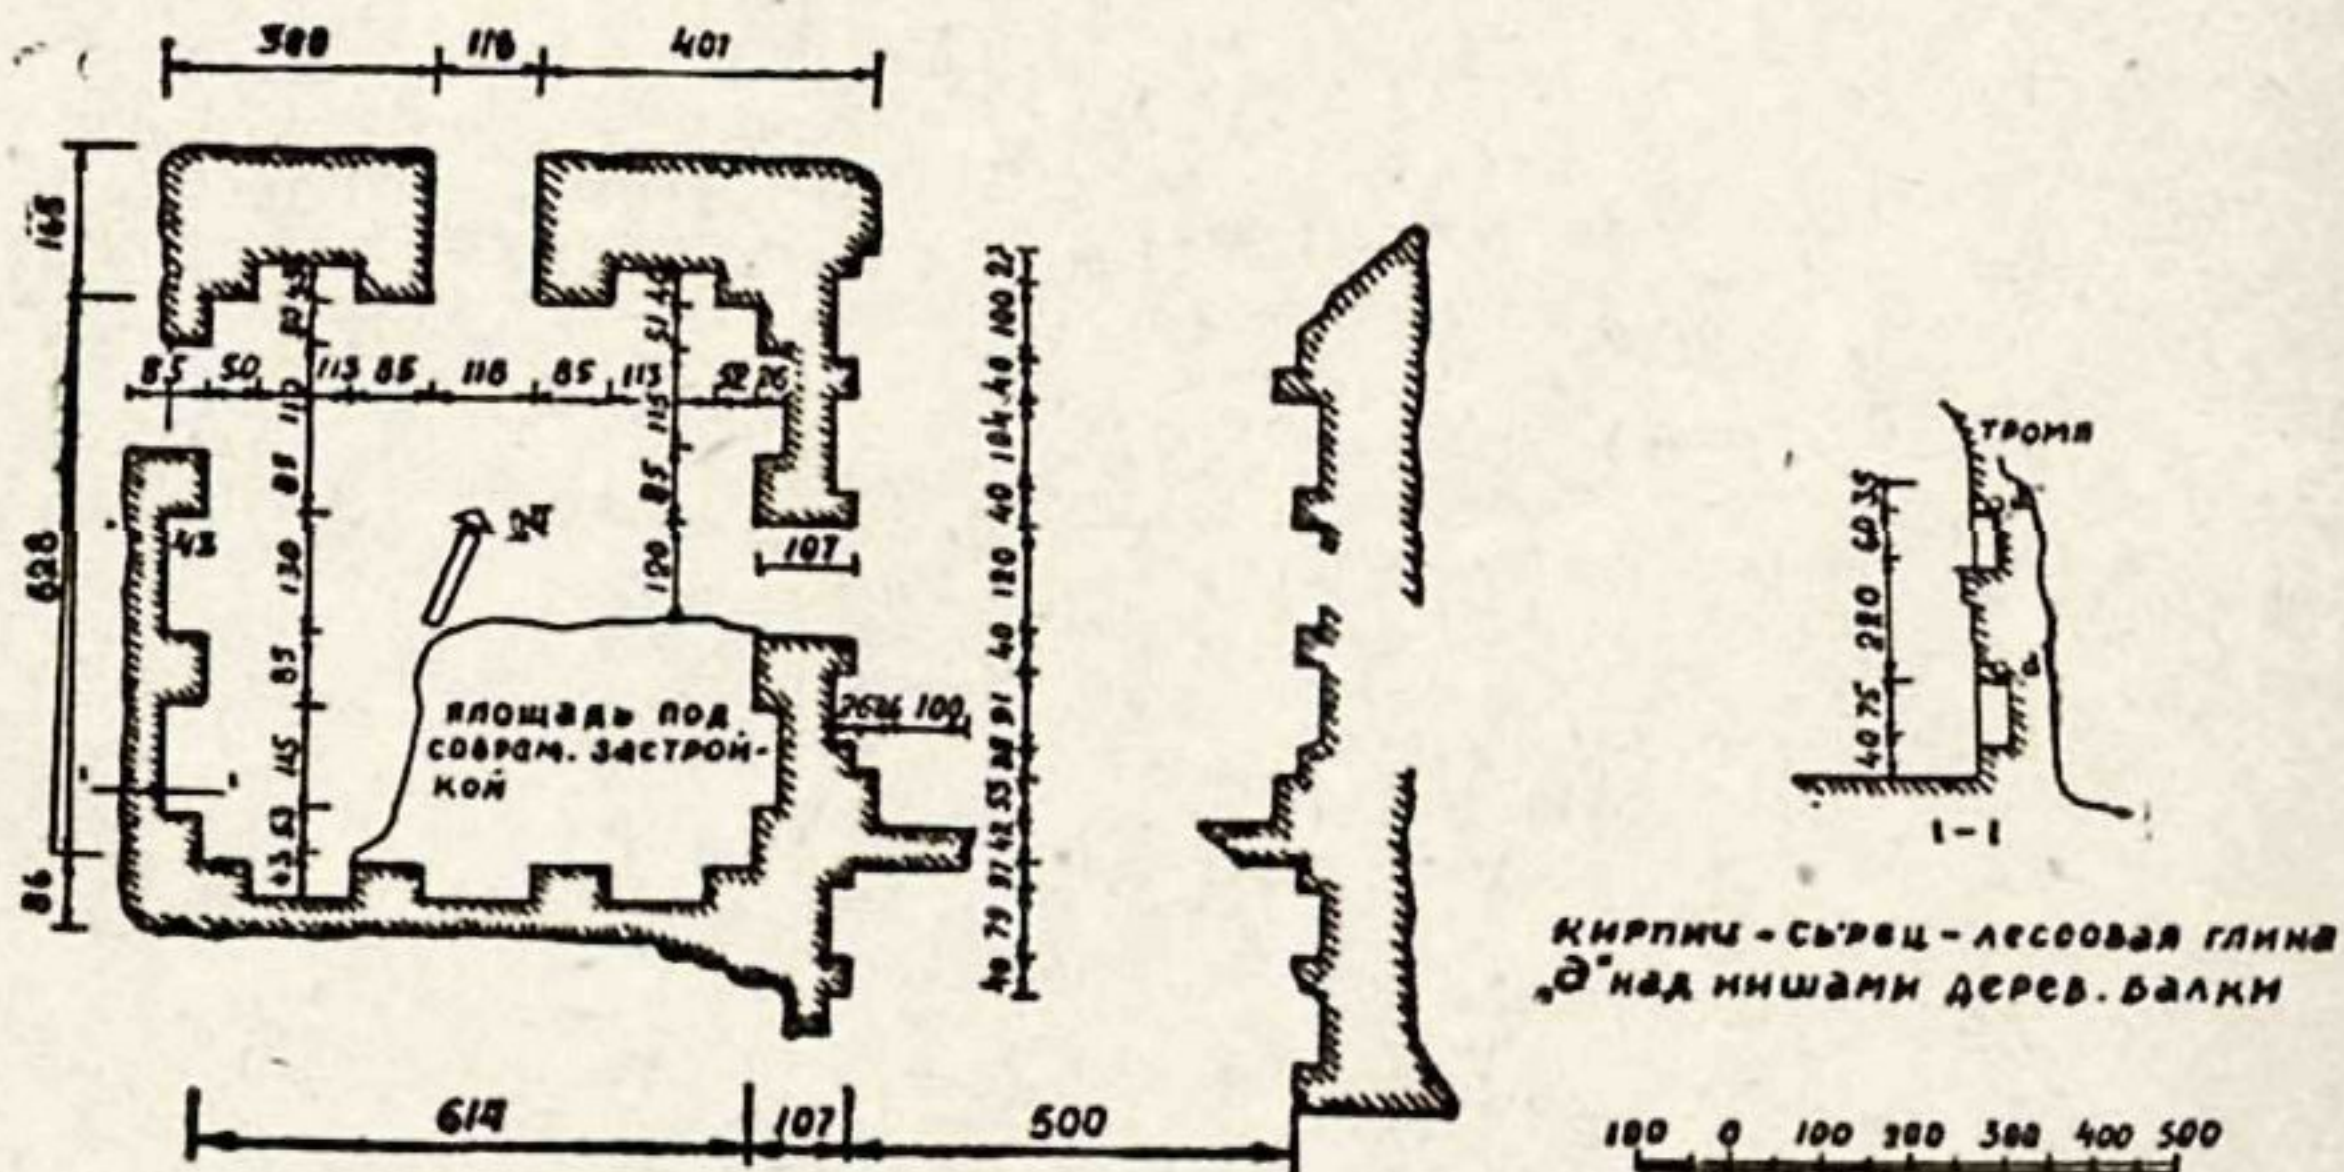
План сырцового здания № 1 и продольный разрез одной из стен здания.
